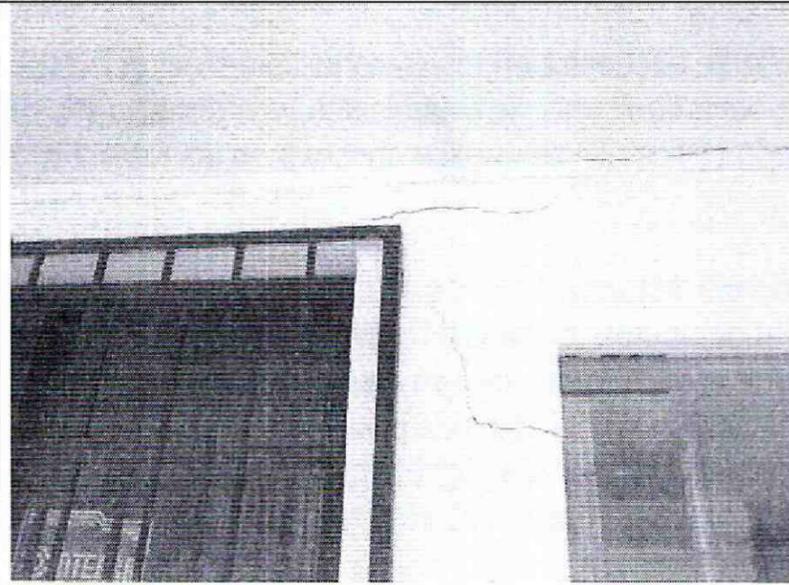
Agrietamientos parte alta del muro de fachada.
